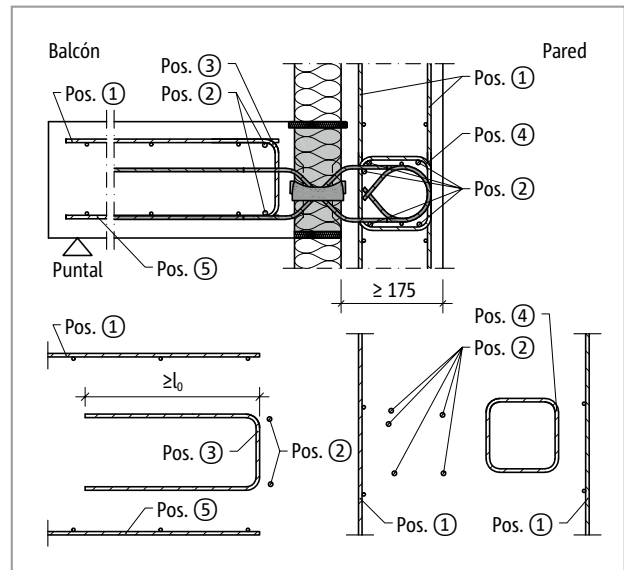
Schöck Isokorb® T tipo Q-VV1 hasta Q-VV5: Armadura in situ en la pared
